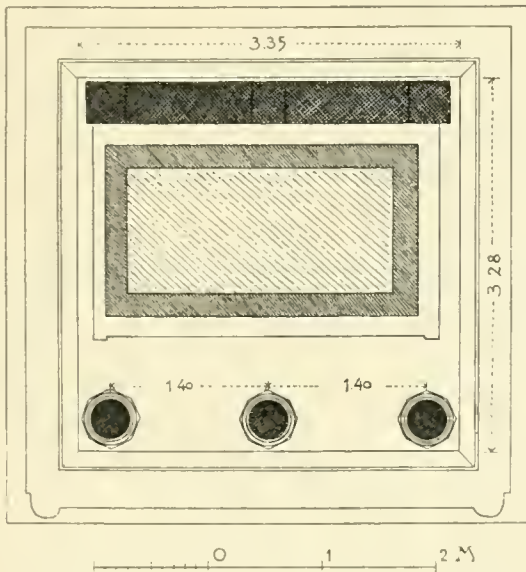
Grundriss des Grabhauses Fig. 64.
